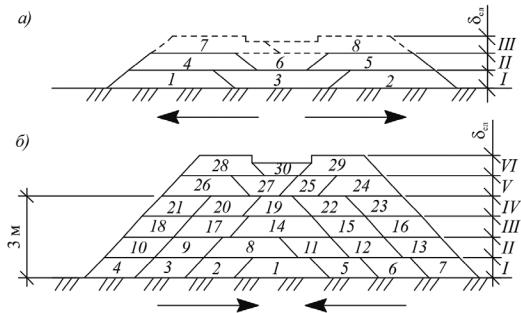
Схемы возведения линейных насыпей из карьерного грунта:
